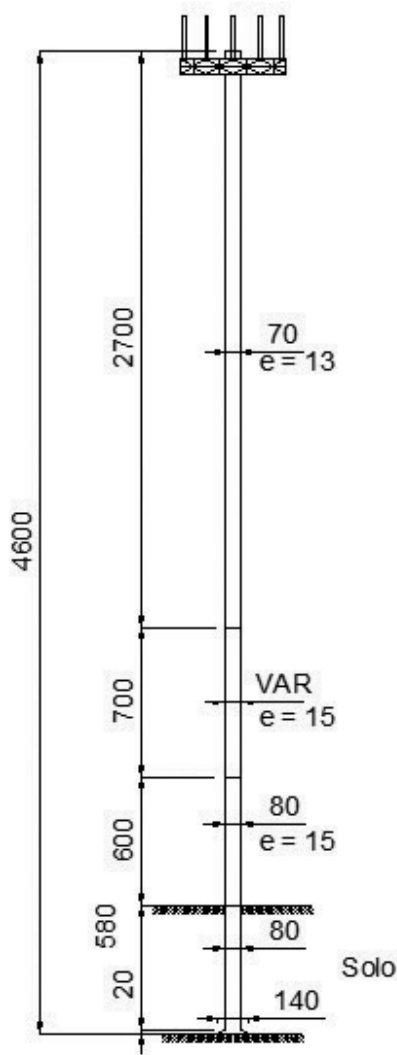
Estrutura 4: geometria - medidas em centímetros.
